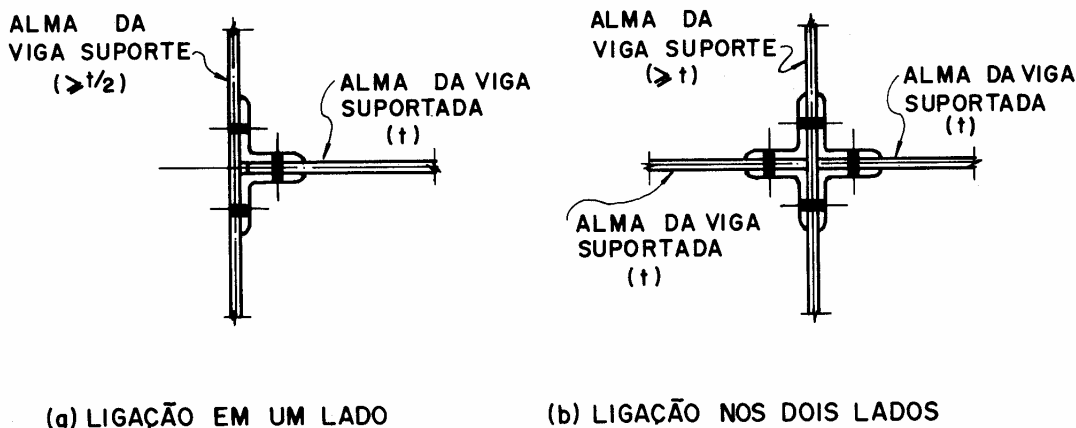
Ligações De Um Lado e Dois Lados Na Viga Suporte
